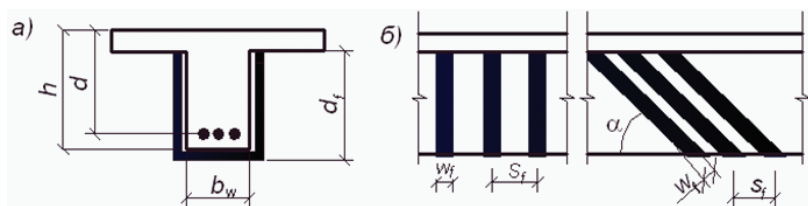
Размещение хомутов из ВКМ для усиления наклонных сечений
